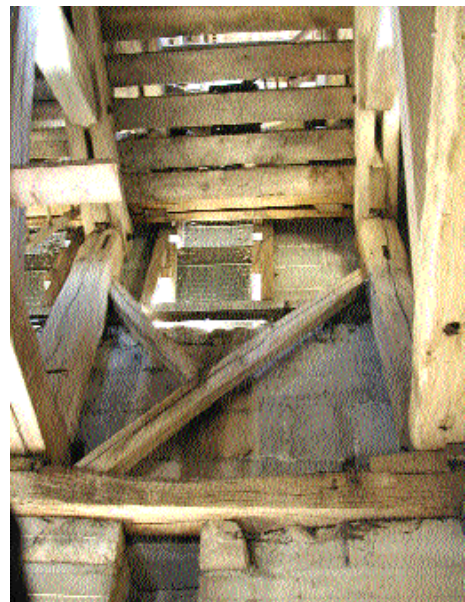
Pan latéral nord avec les restes d'une croix de Saint André assemblée en tête aux poteaux et en pied dans la sablière.
